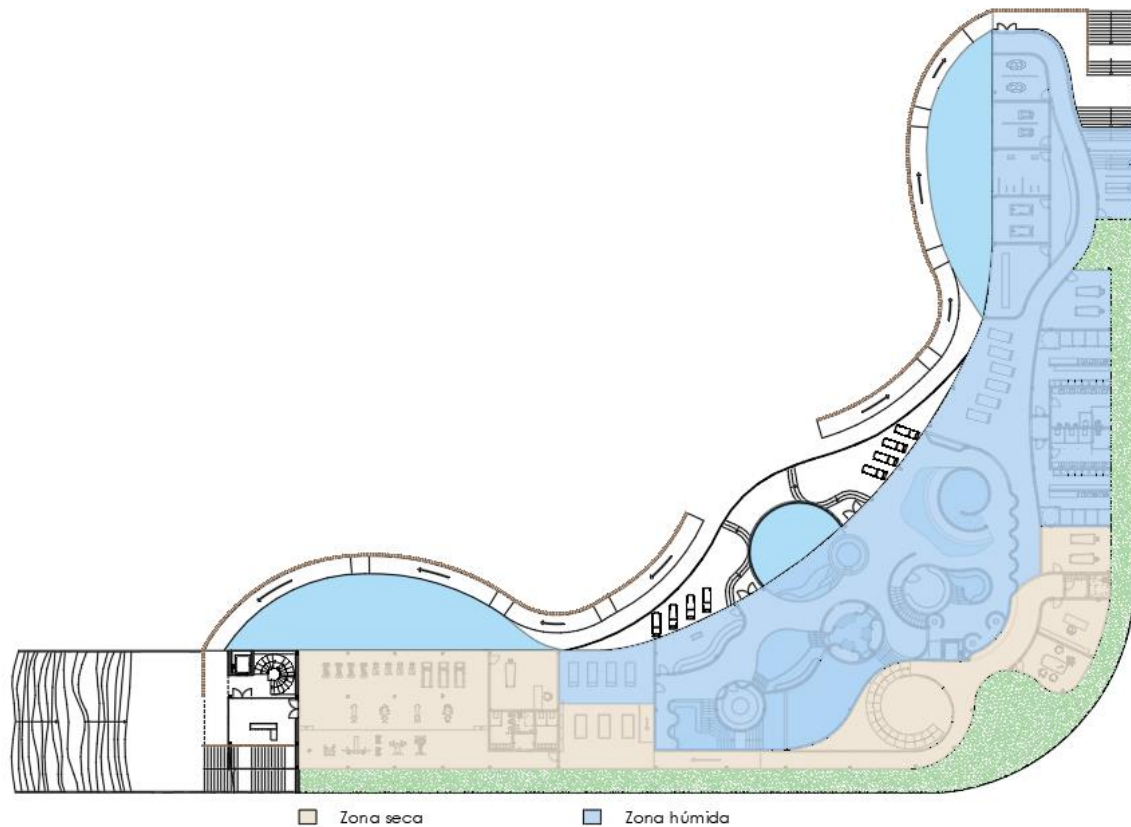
PLANTA DA ZONA HÚMIDA E SECA
